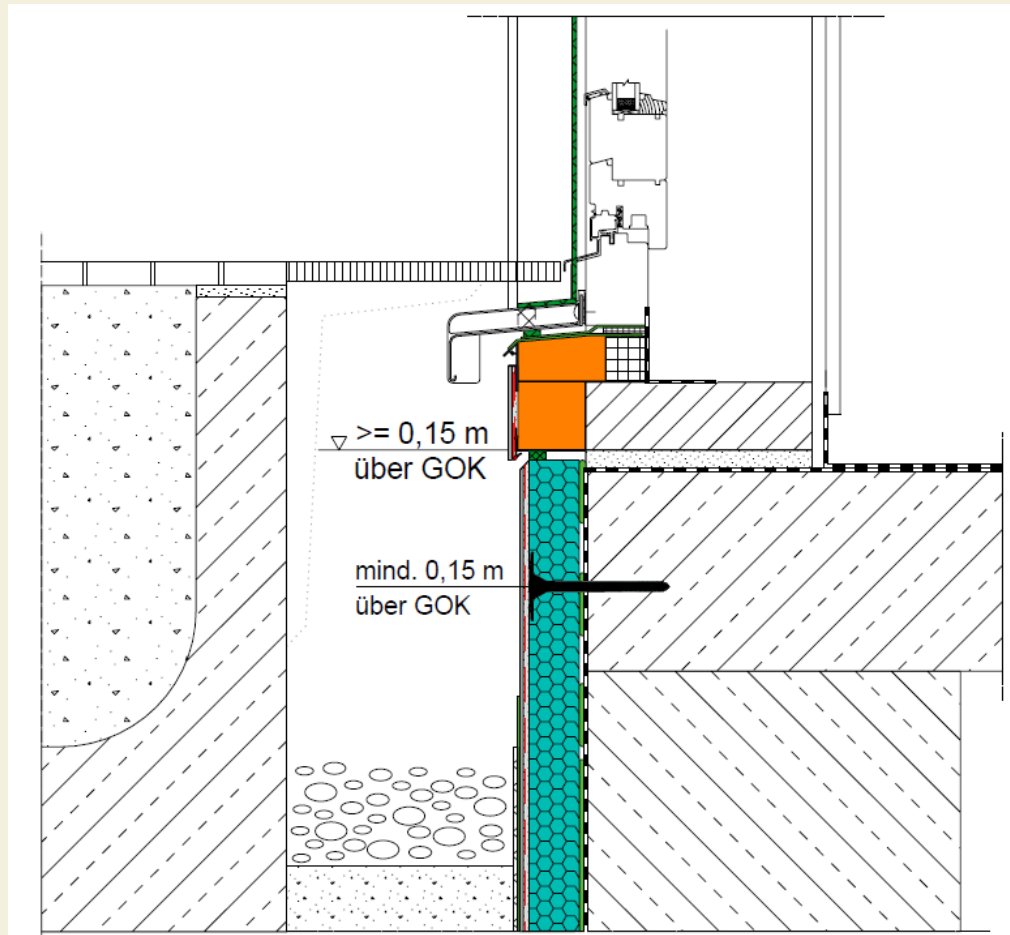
Außenwand-Fußpunkt ebenerdiger Terrassenaustritt
